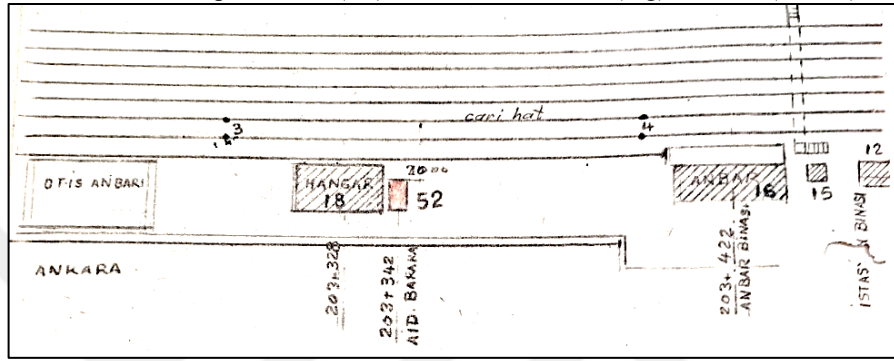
Malzeme Ambarına Ait Plan (TCDD).
